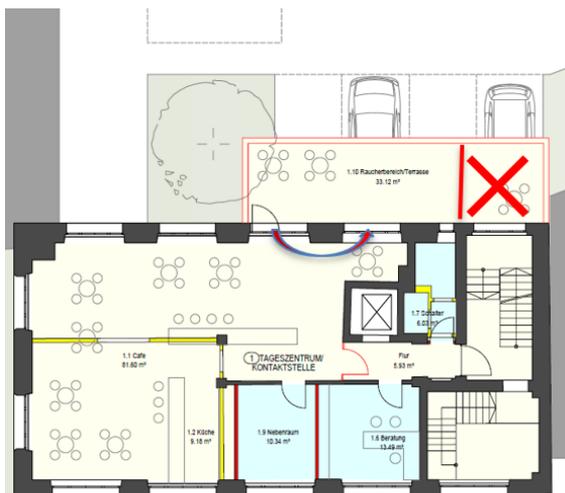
Grundriss des Hochparterres der Katharinenstraße 2b
